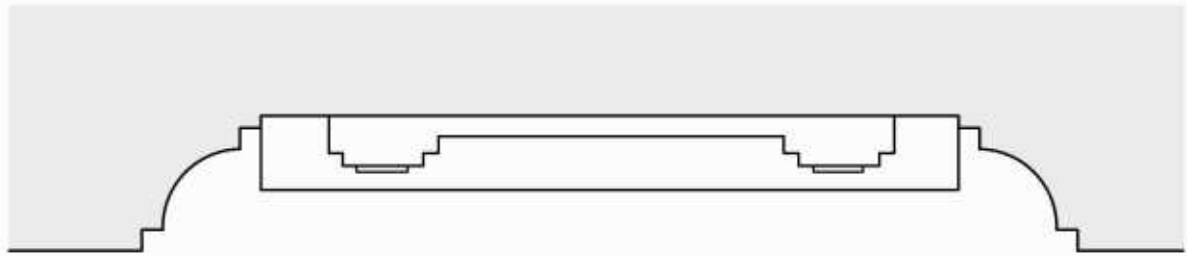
Possibile ricostruzione della pianta AA', con il piano di fondo liscio.
